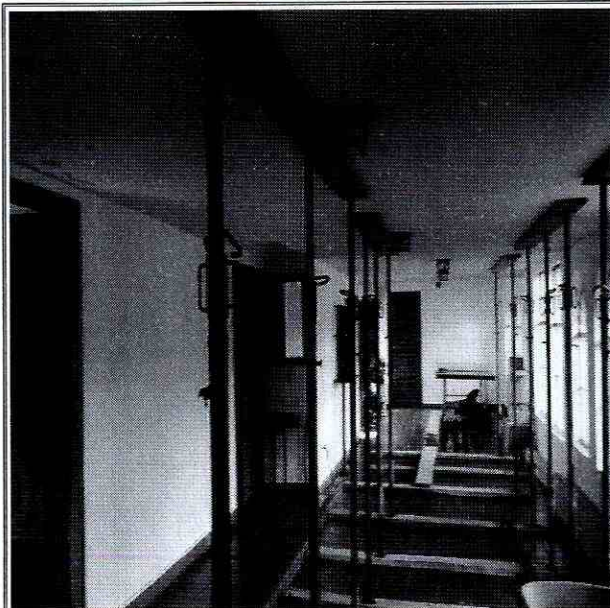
Apuntalamientos en el sector del garaje de la vivienda
